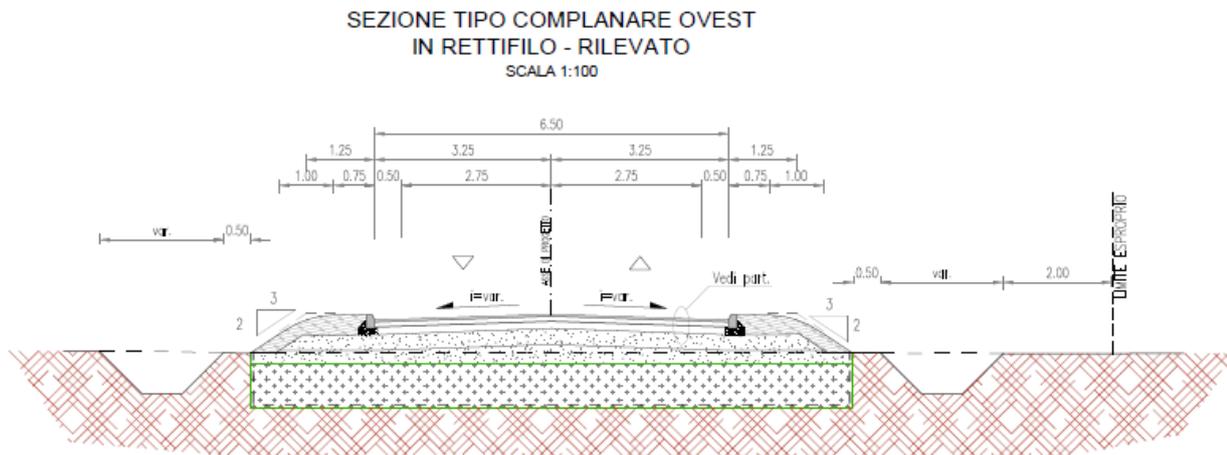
Sezione Tipo Complanare Ovest in rettifilo
